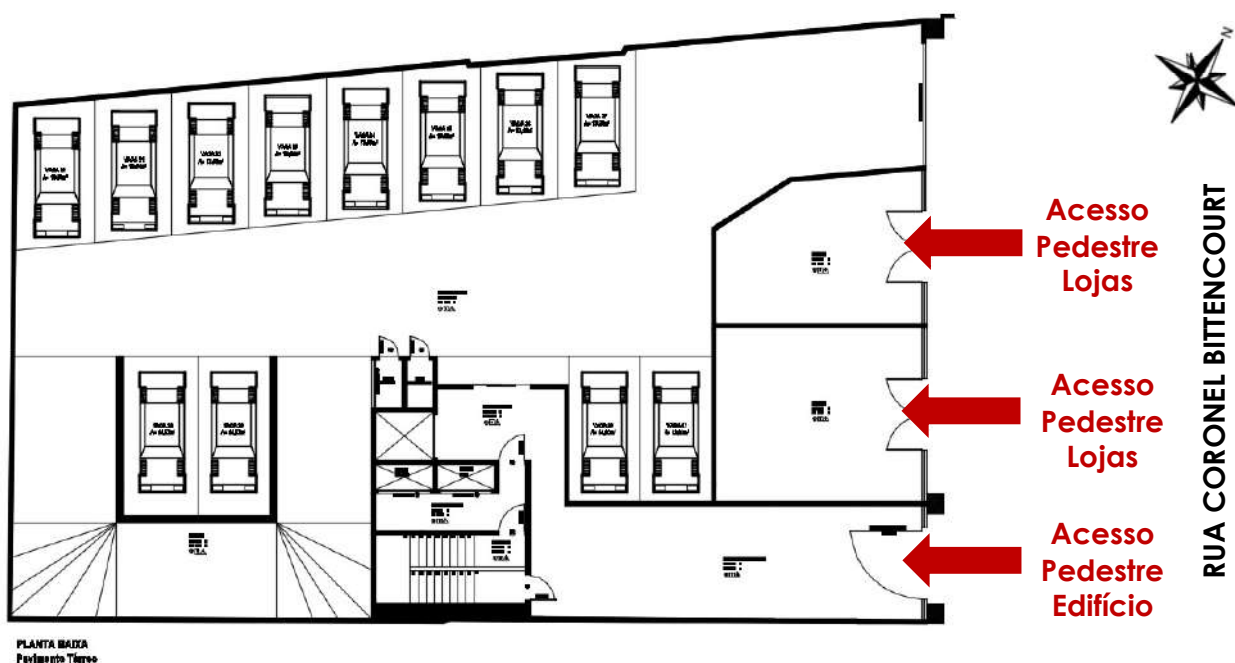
Planta Baixa Pavimento Térreo - Acesso de pedestres
